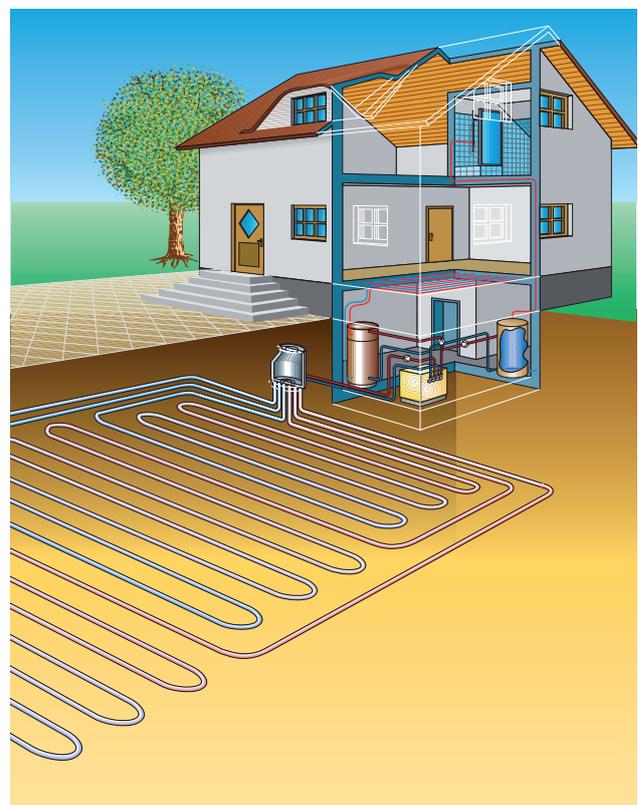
Erdreich Wärmepumpe mit Flächenkollektor
